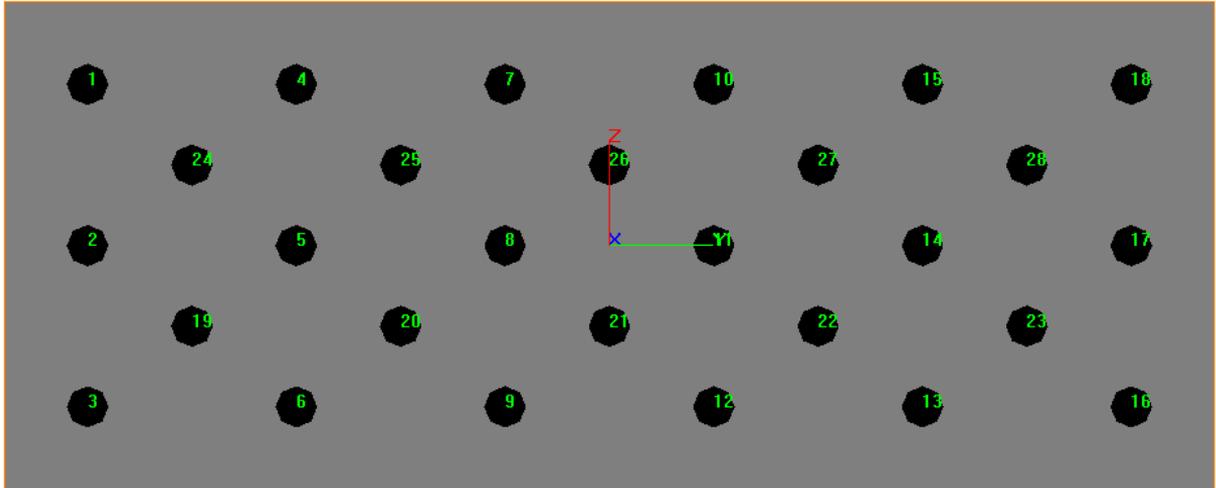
Schema Group della palificata - fondazione esistente (1/2 Spalla)
